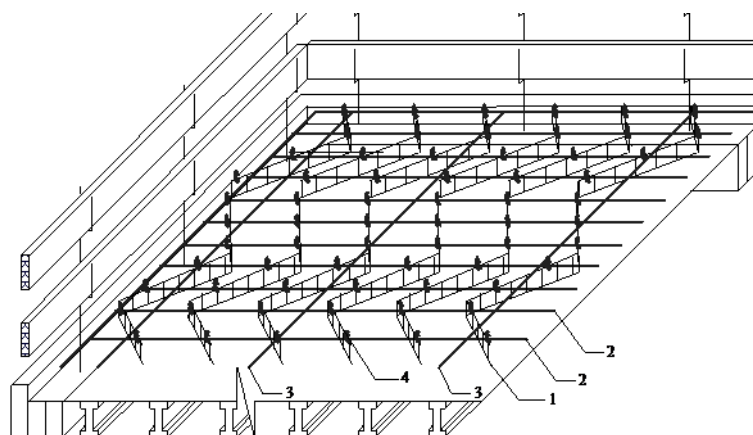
Устройство верхней арматурной сетки: 1 — поддерживающие каркасы; 2 — поперечные арматурные стержни верхней сетки, уложенные с проектным шагом; 3 — продольные арматурные стержни, уложенные с увеличенным пролетом; 4 — закрепление верхних поперечных стержней к поддерживающим каркасам с помощью вязальной проволоки
